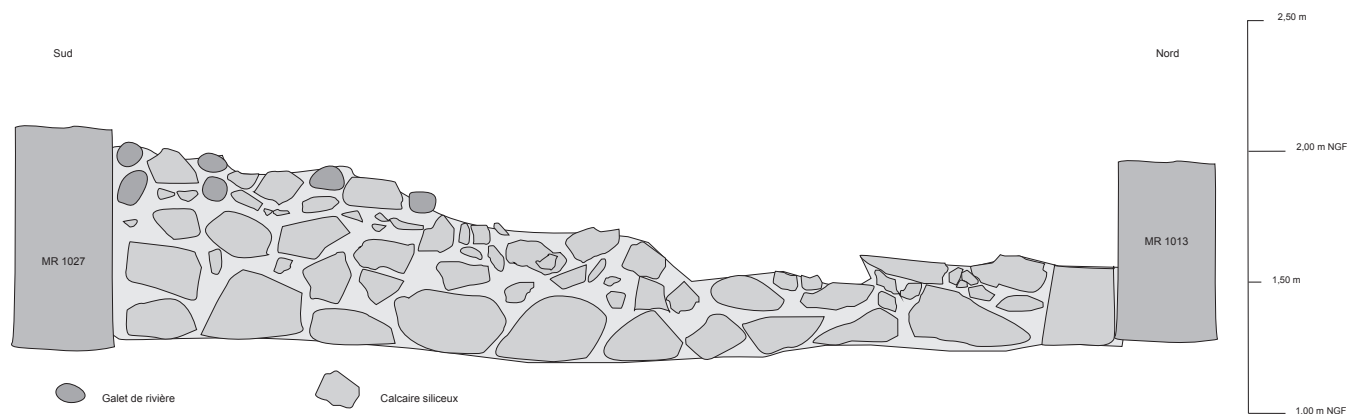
relevé pierre à pierre du parement est du mur MR 1028 (dessin et DAO Ph. Aycard, M. Valente/CAV).
